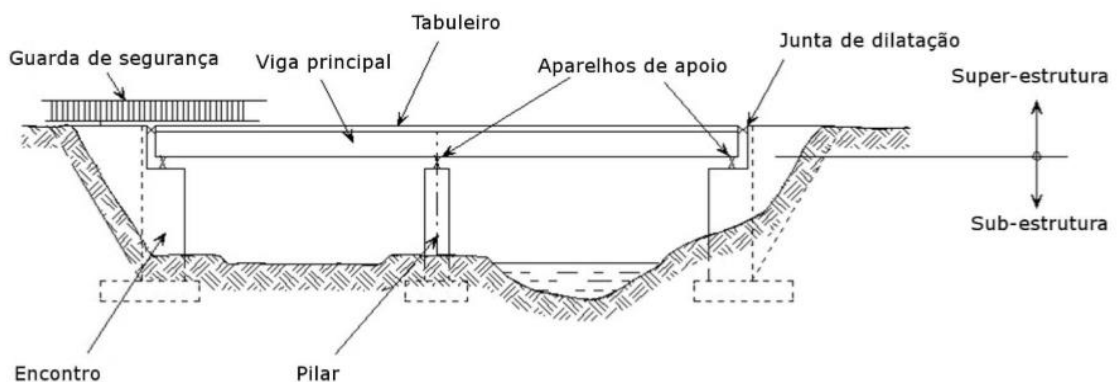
Disposição de uma ponte em viga corrente [W1]
